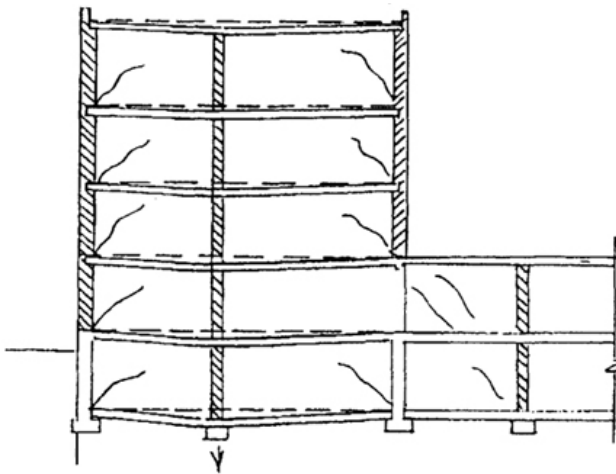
Схемы трещин при значительной осадке средней стены
